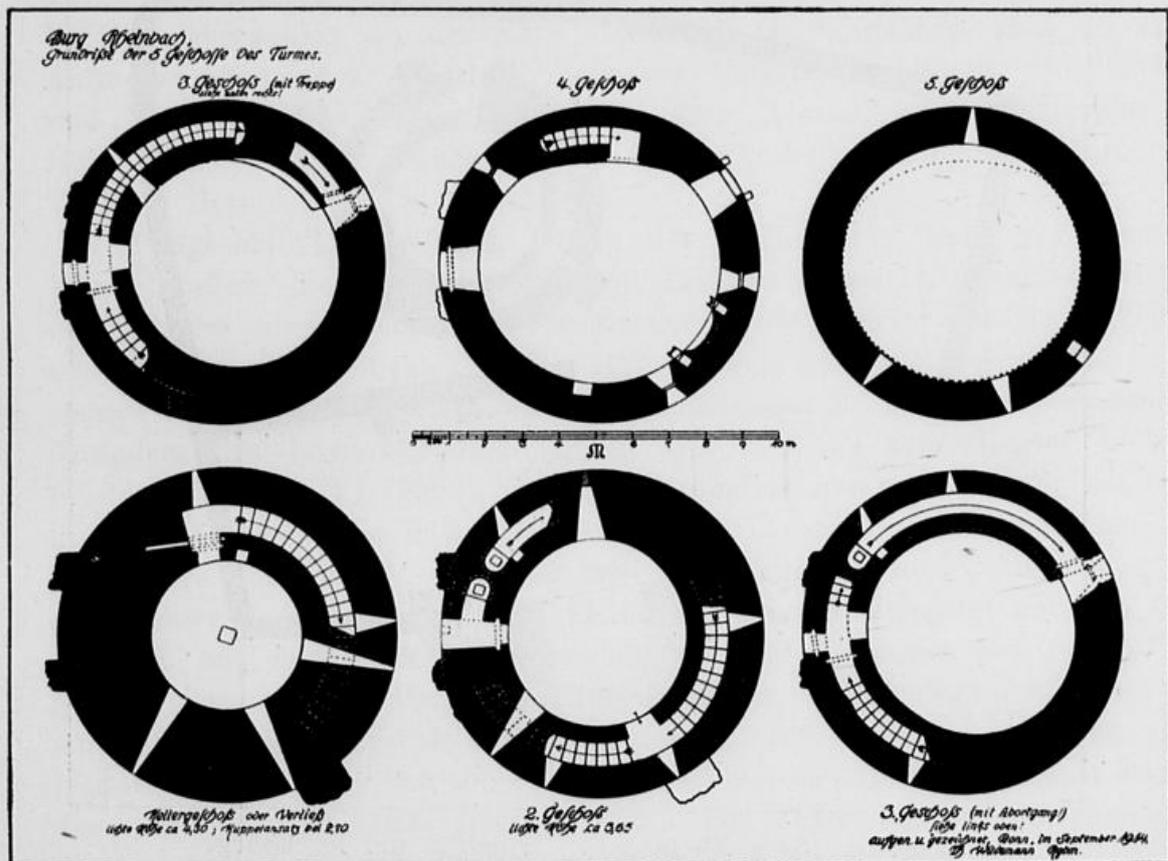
Burg Rheinbach. Grundrisse des Bergfrids.
